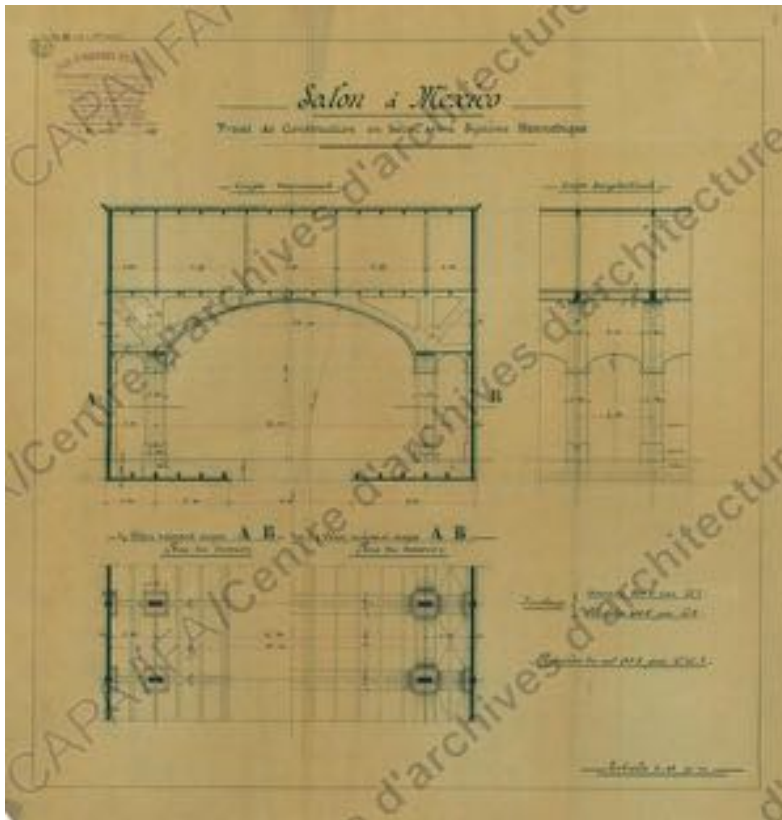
Arriba: Salón en México. Proyecto de Construcción en hormigón armado Sistema Hennebique. [Salon à Mexico. Projet de Construction en béton armé Système Hennebique.]
